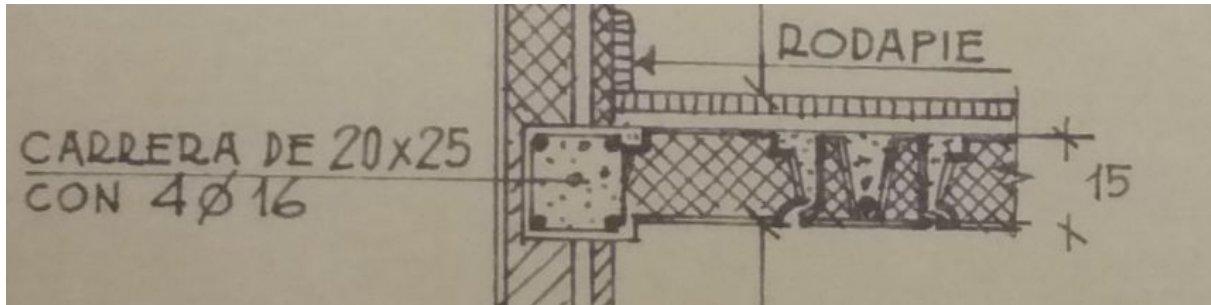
Sección forjado (Fuente: Ayuntamiento de Castellón de la Plana)
